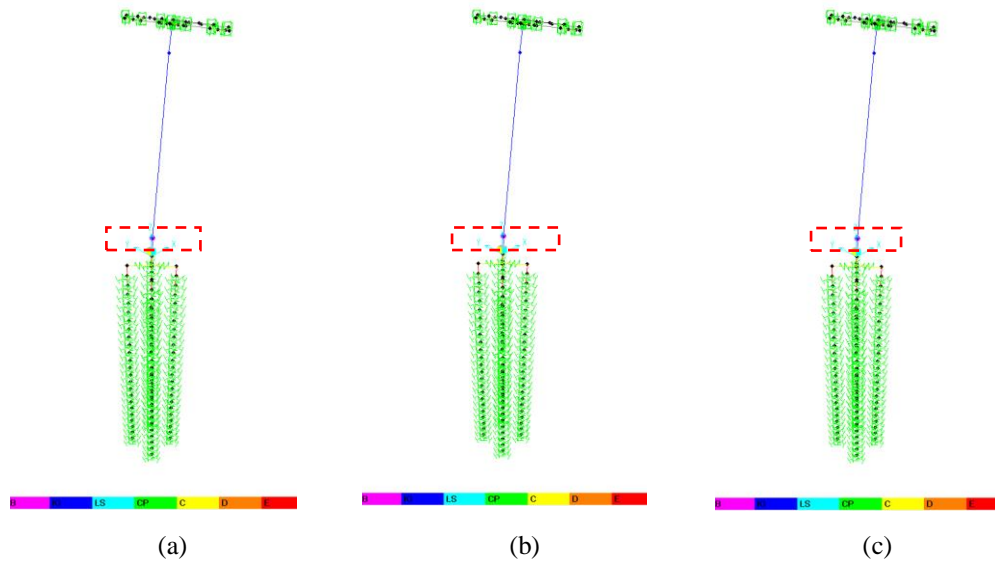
12 Lokasi Leleh Pertama pada Struktur (a) LRB tipe 1; (b) LRB tipe 2; (c) LRB tipe 3 Pushover pada Pier
